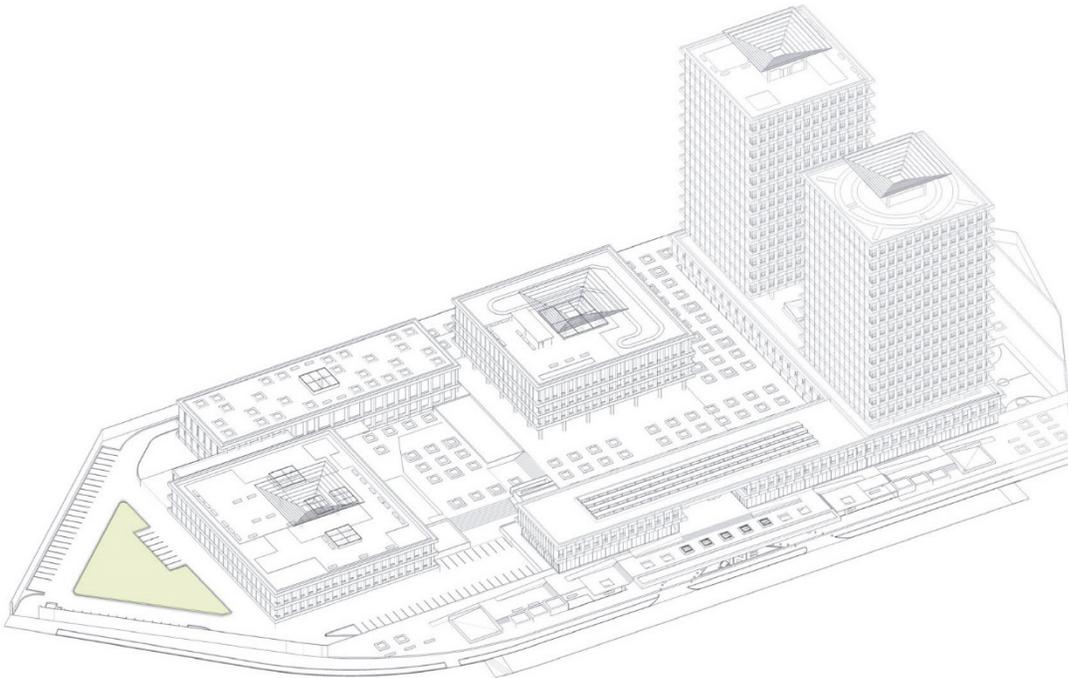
Etapa 3 de (PE). Plazas y Obras Exteriores.
